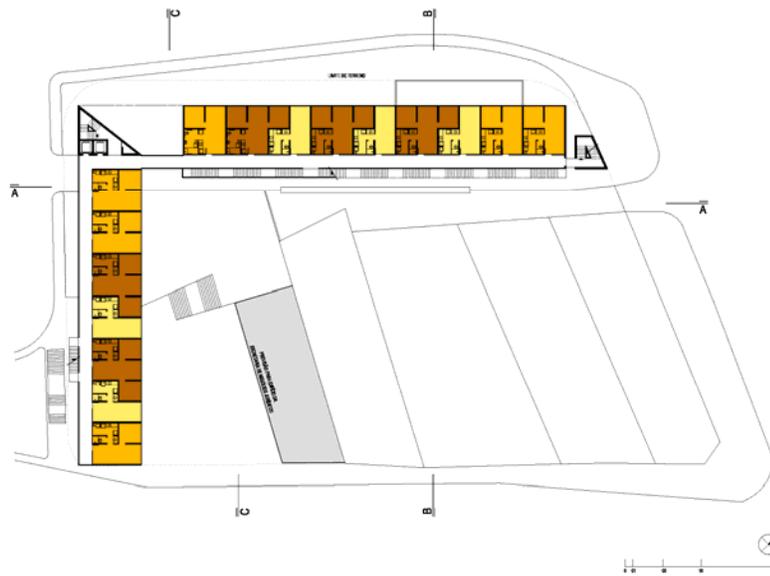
Planta: pavimento-tipo (s/esc).
